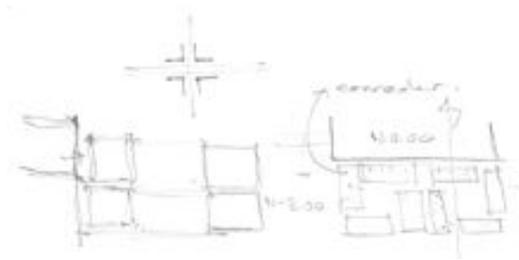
Aproximación a la planta arquitectónica con el partido tomado.
